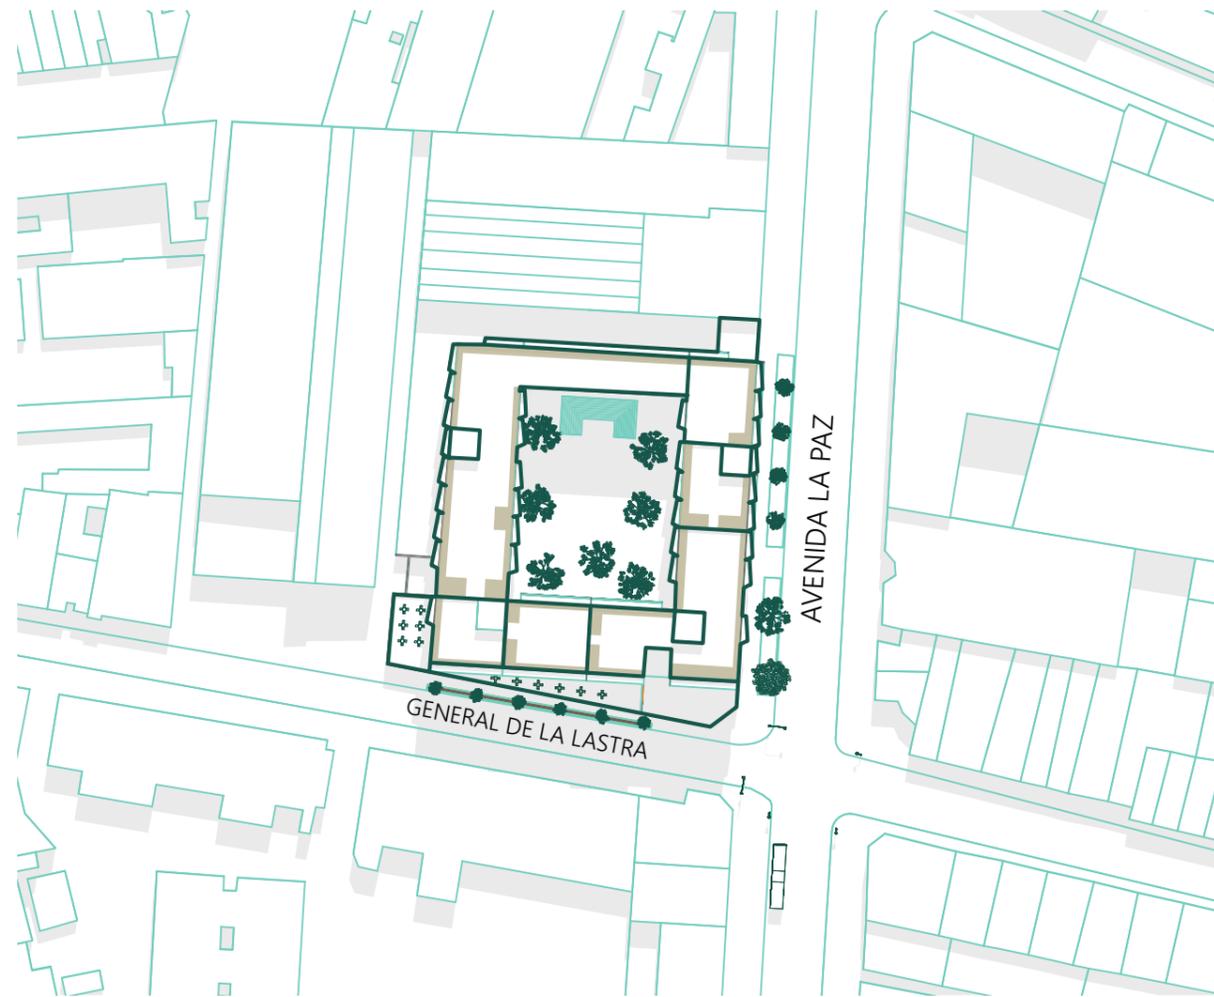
Planta de emplazamiento. Planimetría en proceso. Elaboración propia.
